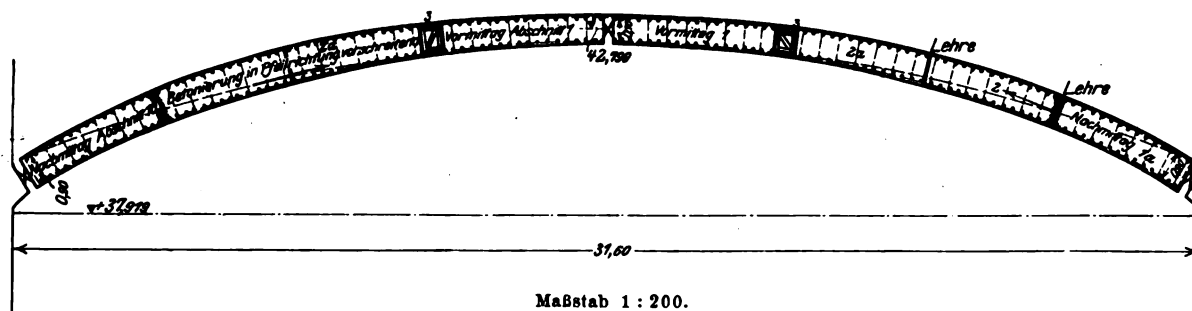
Betonierungsvorgang an einem Gewölbe.
